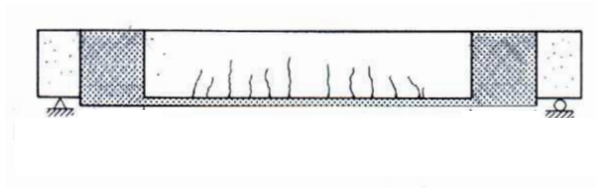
Renforcement complémentaire par des plaques collées sur les côtés de la poutre à l'extrémité du renfort
